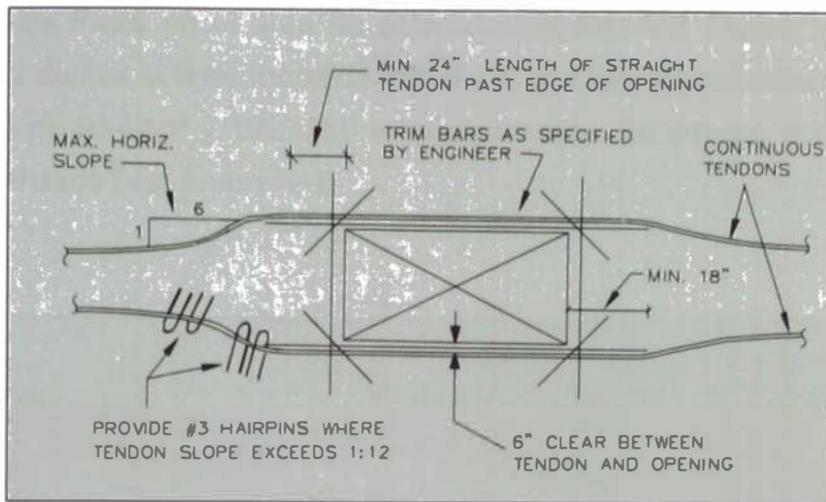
Distancias mínimas y refuerzos adicionales en ductos de losas Postensadas
